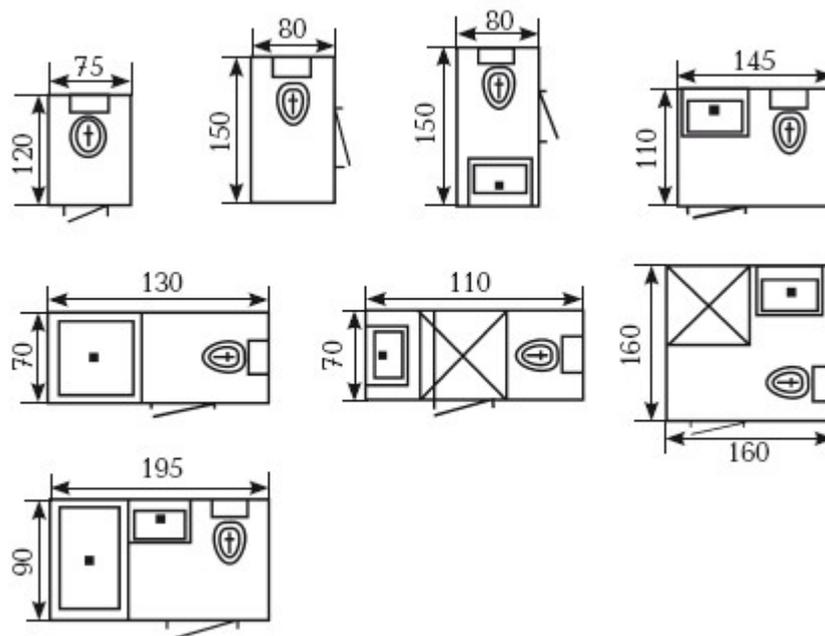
Возможные варианты планировки санитарно-гигиенических помещений
